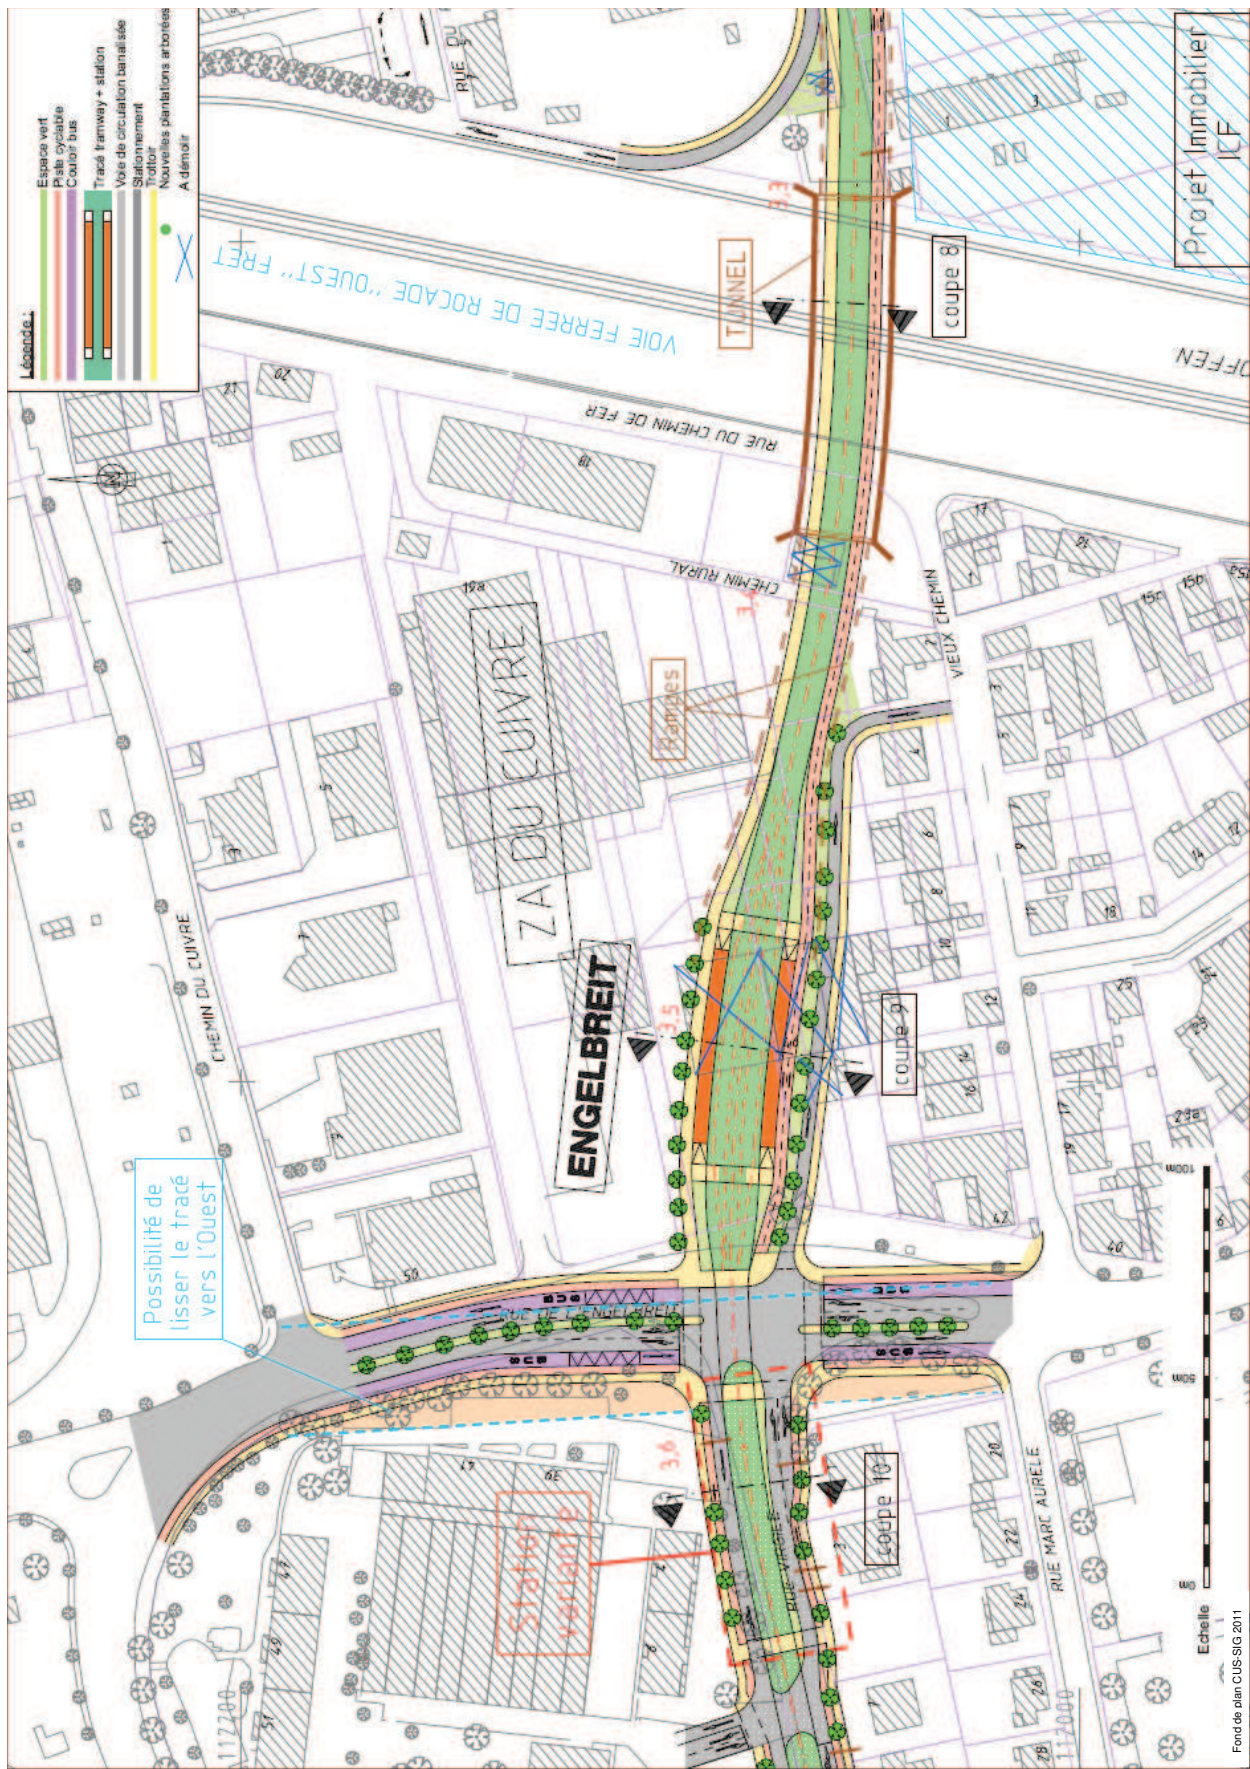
Plan zoom option de franchissement "Tunnel" et ZA Cuivre
